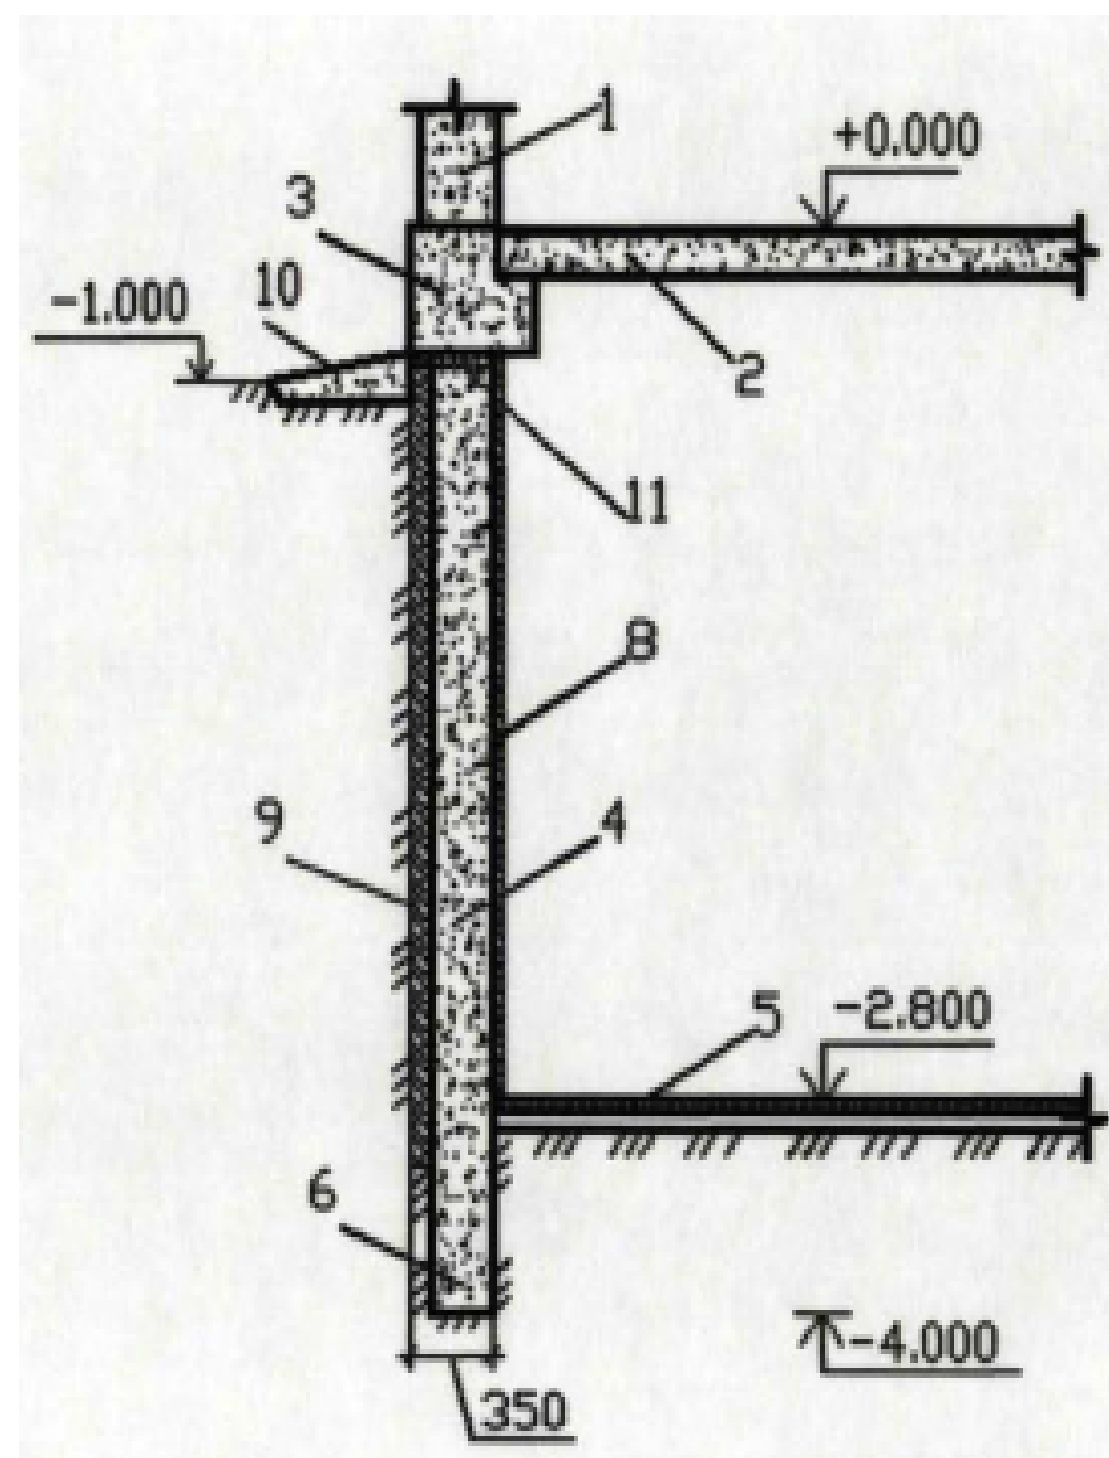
Конструктивна схема фундаментів за розробленою технологією: розріз несучої конструкції з ростверком і підлогою підвалу; 1 – стіна будівлі; 2 – плита перекриття над підвалом; 3 – ростверк; 4 – стіна підвалу, зведена способом «стіна в ґрунті»; 5 – підлога підвалу з гідроізоляцією; 6 – закладення стіни в ґрунті; 8 – шар внутрішньої гідроізоляції; 9 – зовнішній гідроізоляційний екран; 10 – вимощення; 11 – відсічна гідроізоляція.
